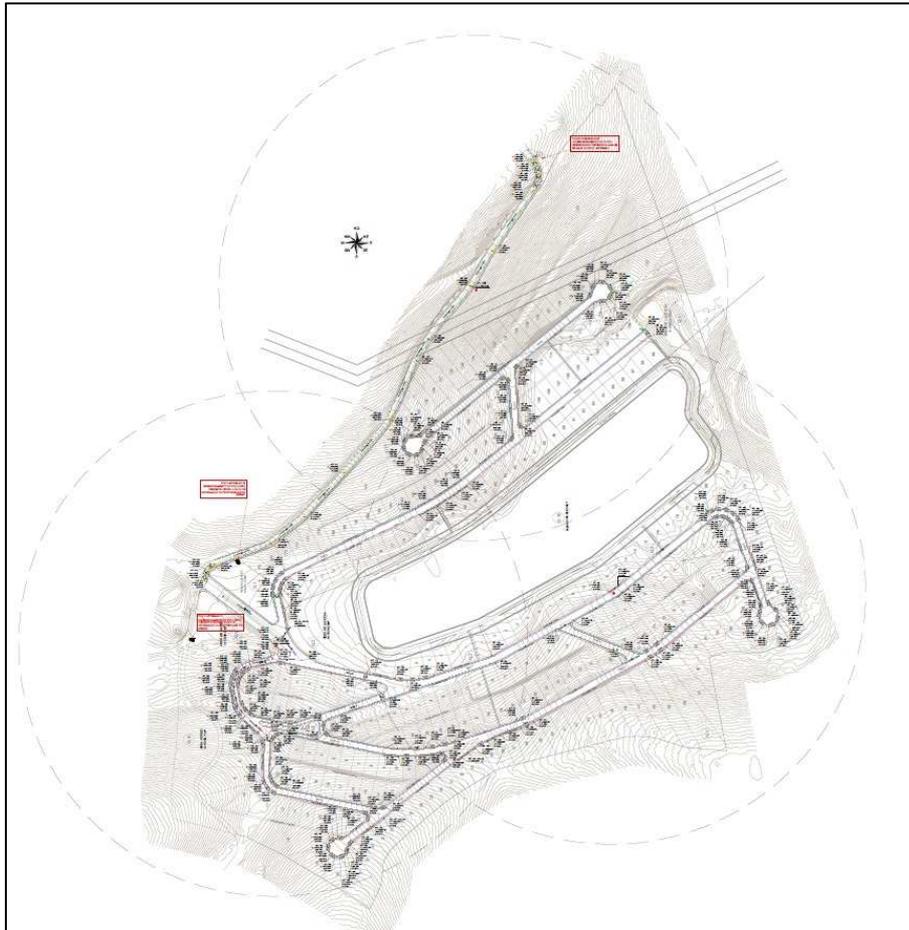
Planta da rede de abastecimento de água do Condomínio Morada do Lago.
